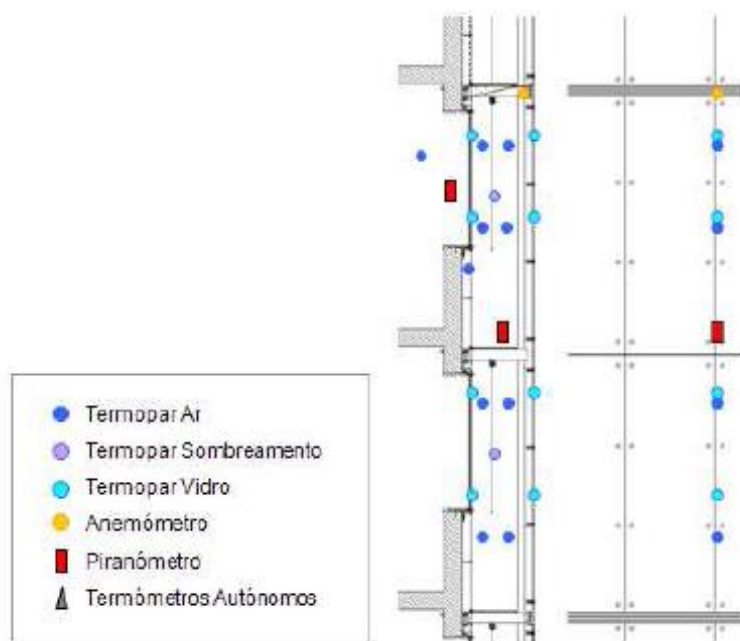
Dispositivos de monitorização colocados na fachada. (Facal n.d.)
